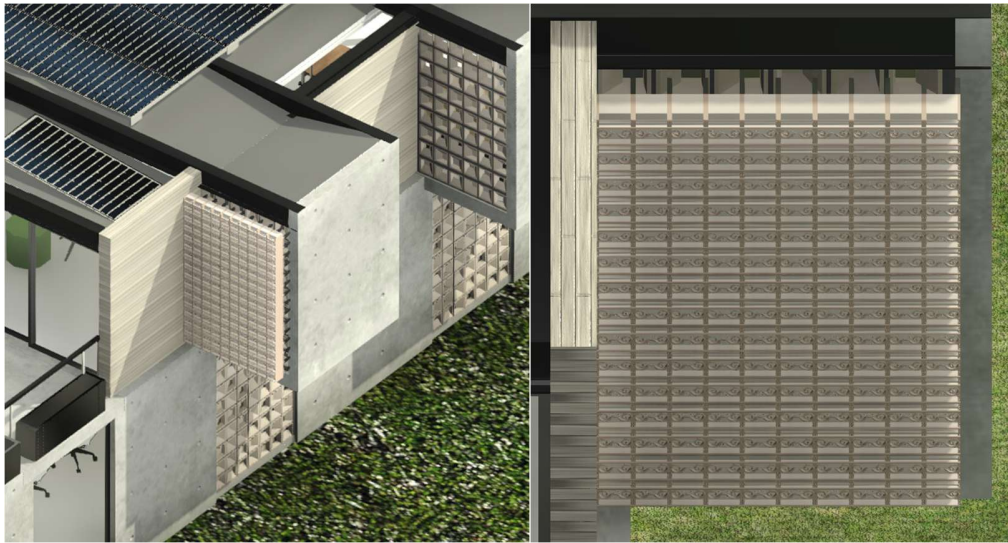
Imágenes del elemento prefabricado de fachada arquitectónico instalado en la fachada de análisis de la Ecovilla UPB, Medellín. Extraídas de modelo 3D – Plataforma Revit
